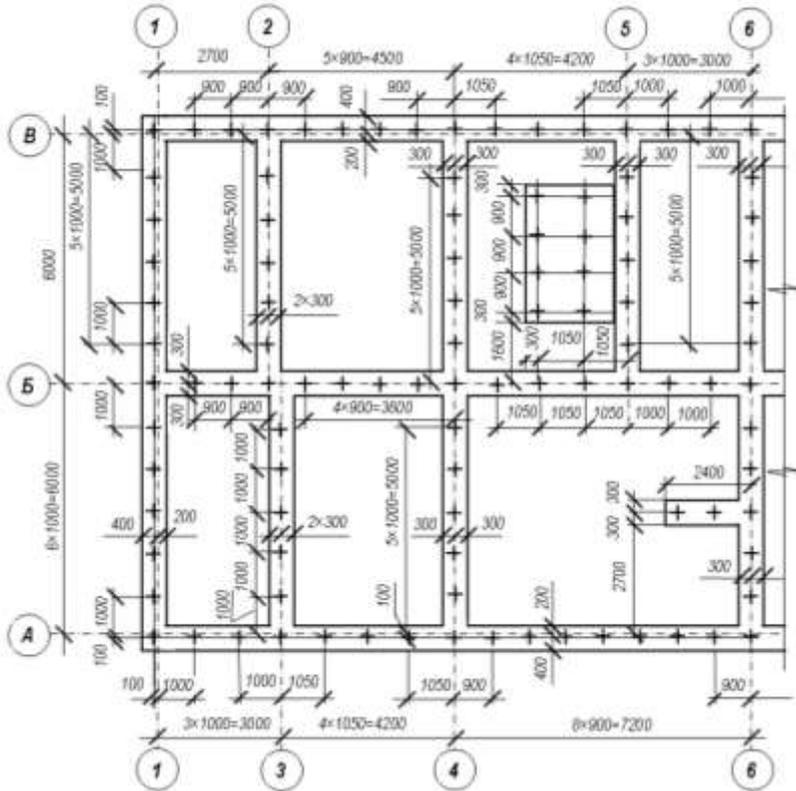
Пример оформления схемы расположения элементов свайных фундаментов жилого дома
